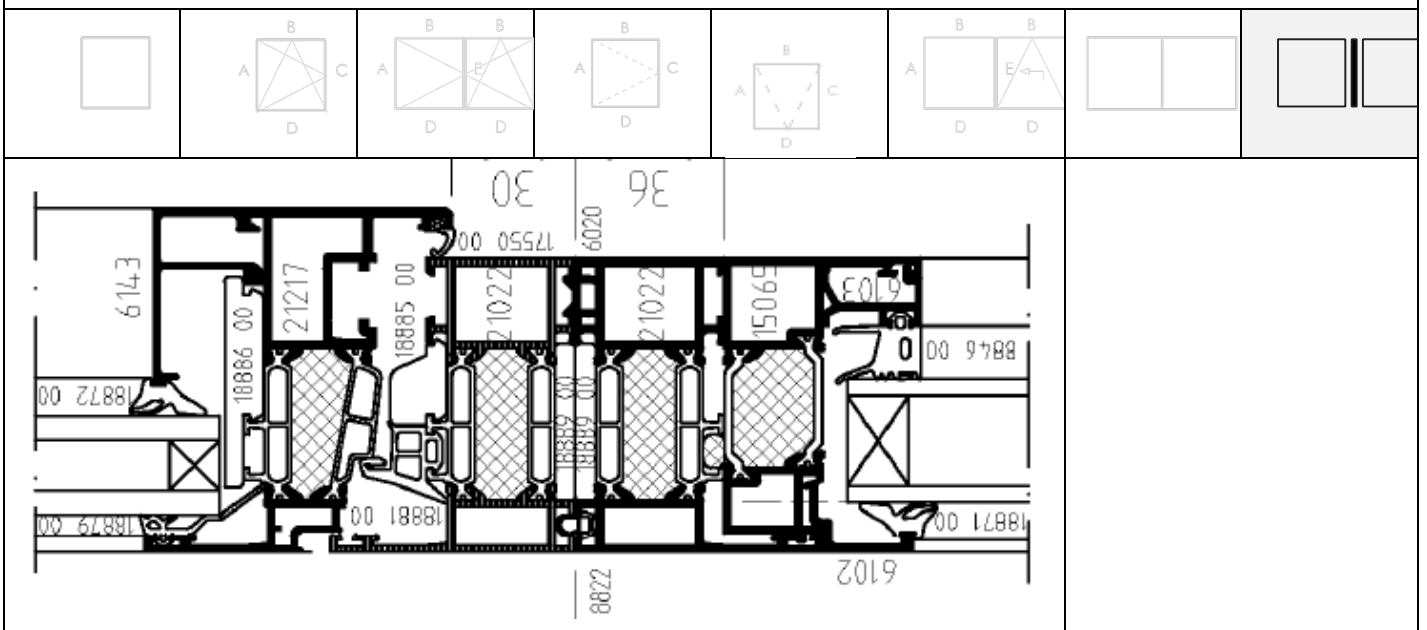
Coupe type porte vitré ouvrant vers l'intérieur
